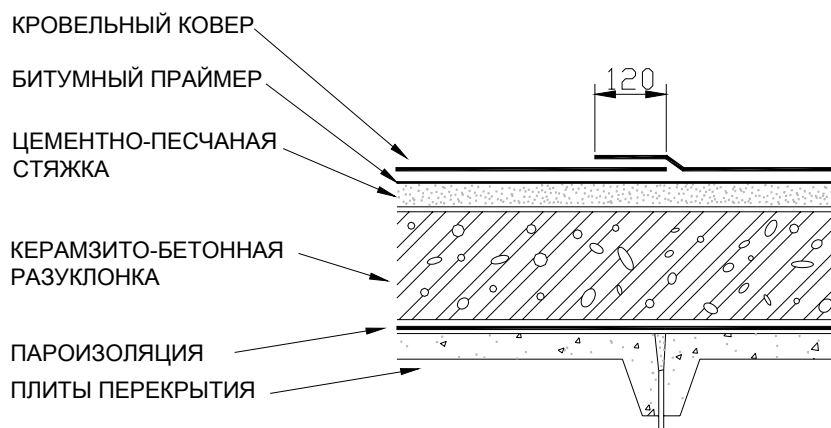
Кровельный ковер по керамзитобетонной разуклонке с армированной цементно-песчаной стяжкой.
